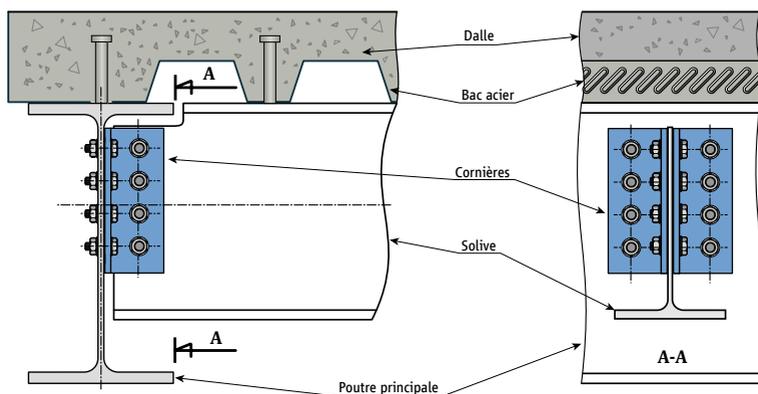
Assemblage d'une solive sur une poutre de rive par double cornière
